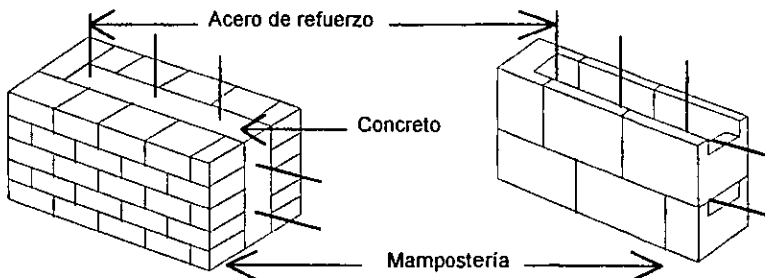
Formas de construcción de mampostería reforzada.
